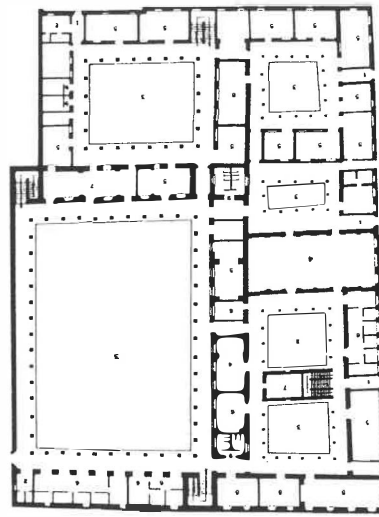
Santo Domingo, Grundriß des ehem. Klosters, Erdgeschoß.
